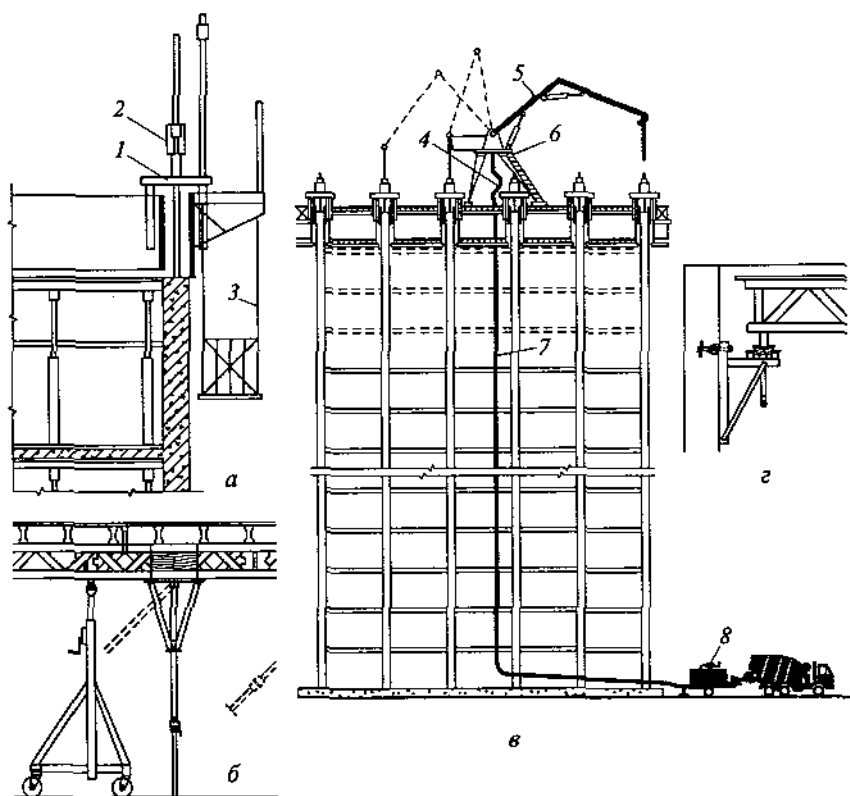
Бетонирование стен в скользящей опалубке с одновременным устройством перекрытий:
